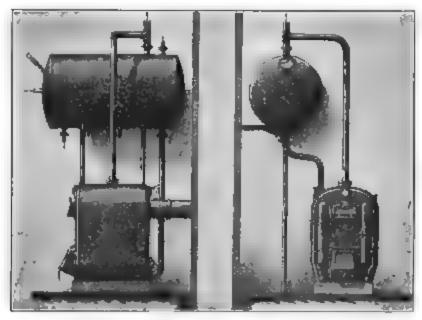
, Abb 227 Warmwasserapparat, betrieben durch einen Heizkessel,
